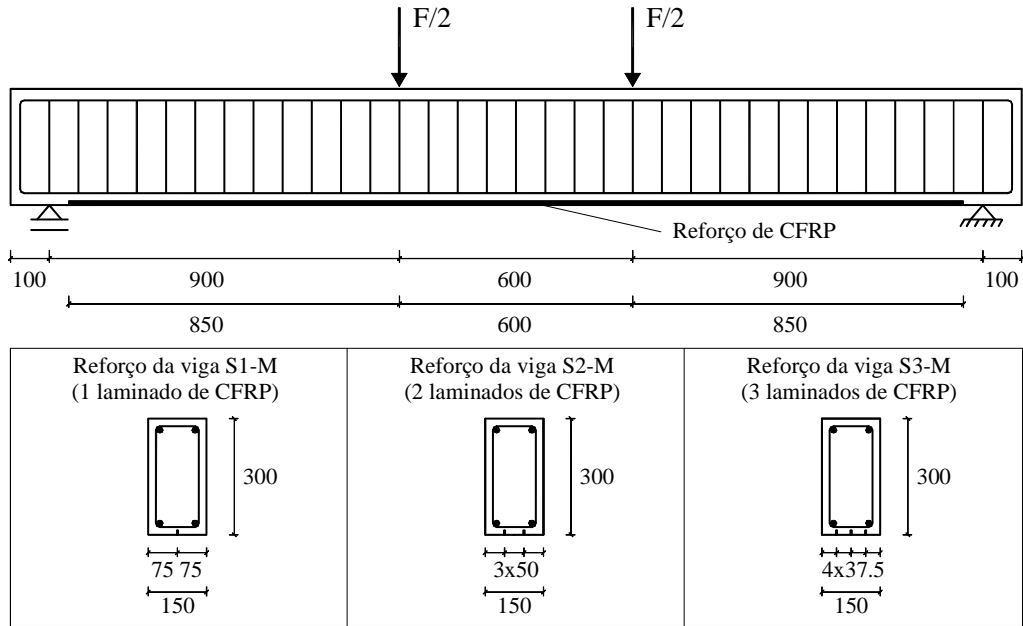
Soluções de reforço de CFRP testadas (dimensões em mm).
